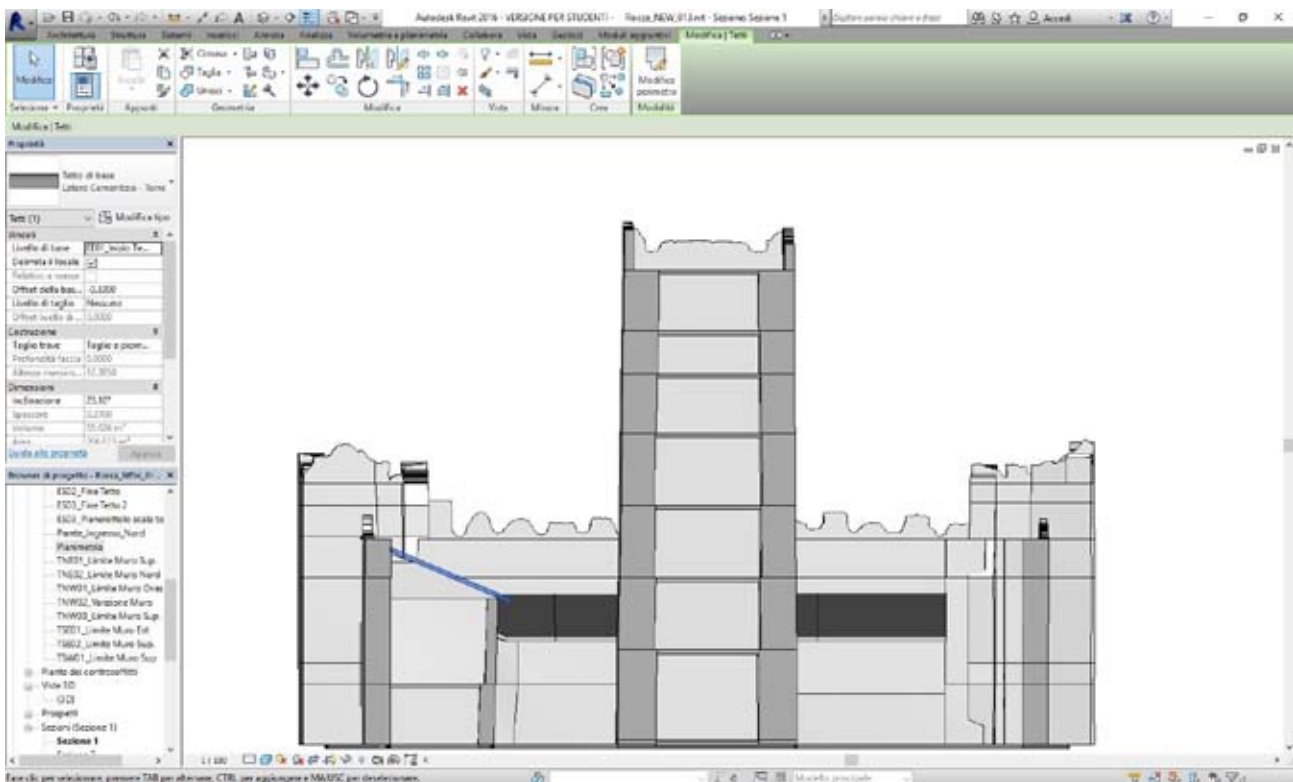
Sezione della muratura completa della Rocca - Autodesk Revit 2016.
